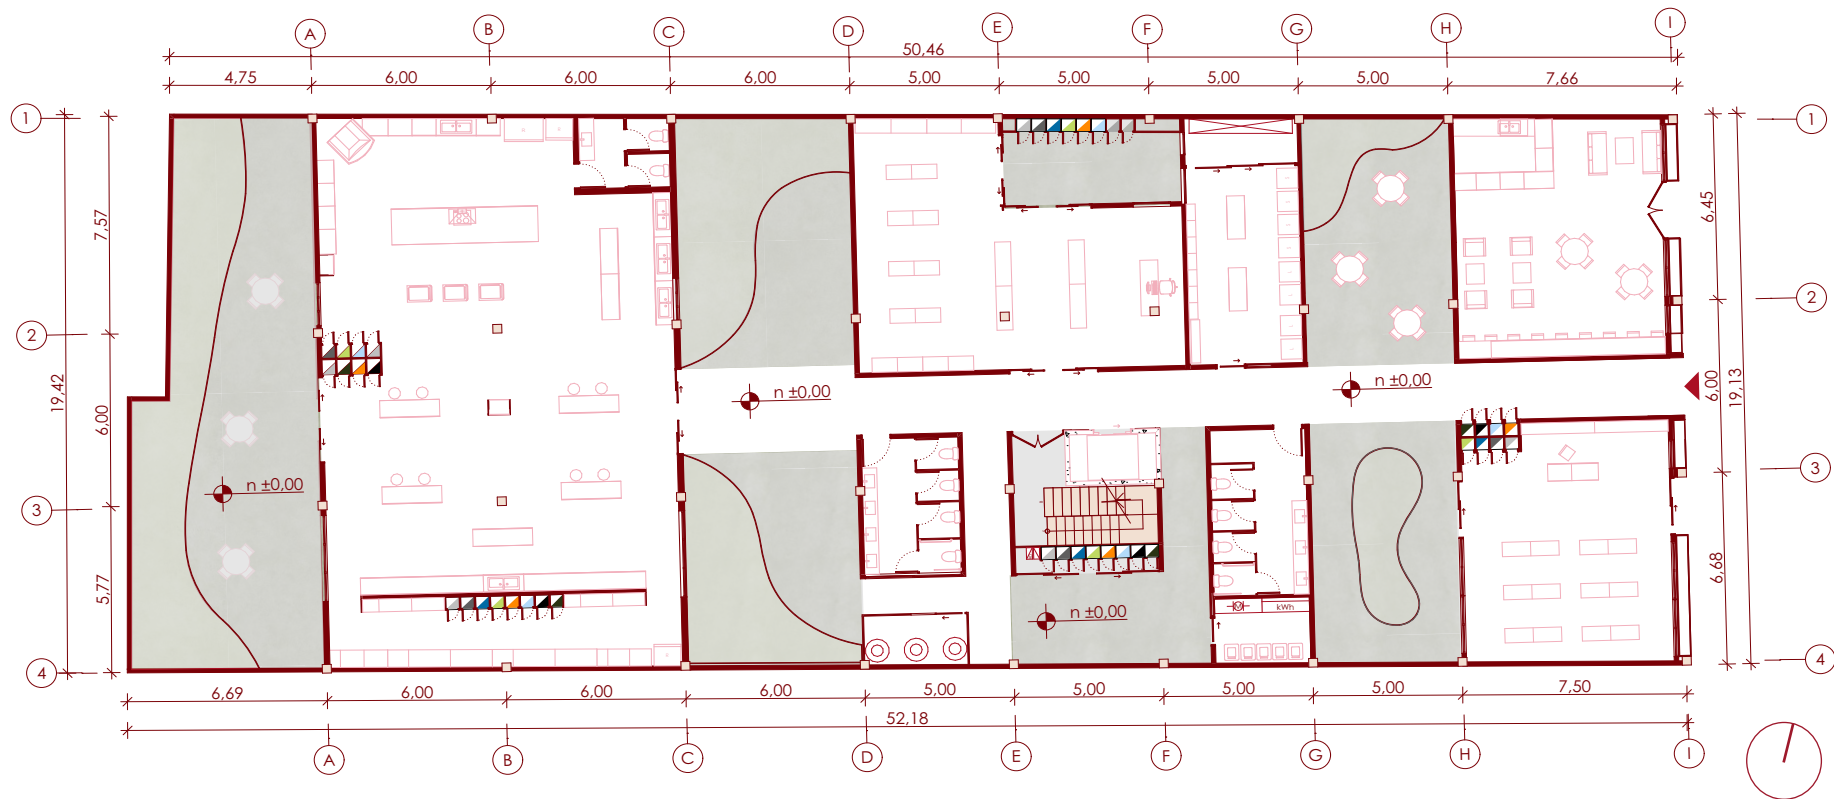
Planta de instalaciones (planta baja del proyecto). Nota. Elaboración propia.
